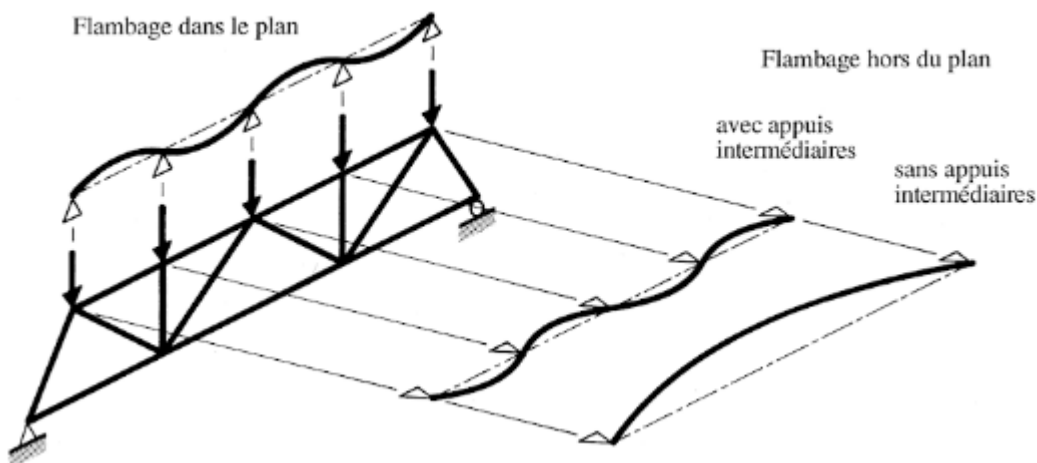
Flambement de la membrure comprimée d'une poutre à treillis
